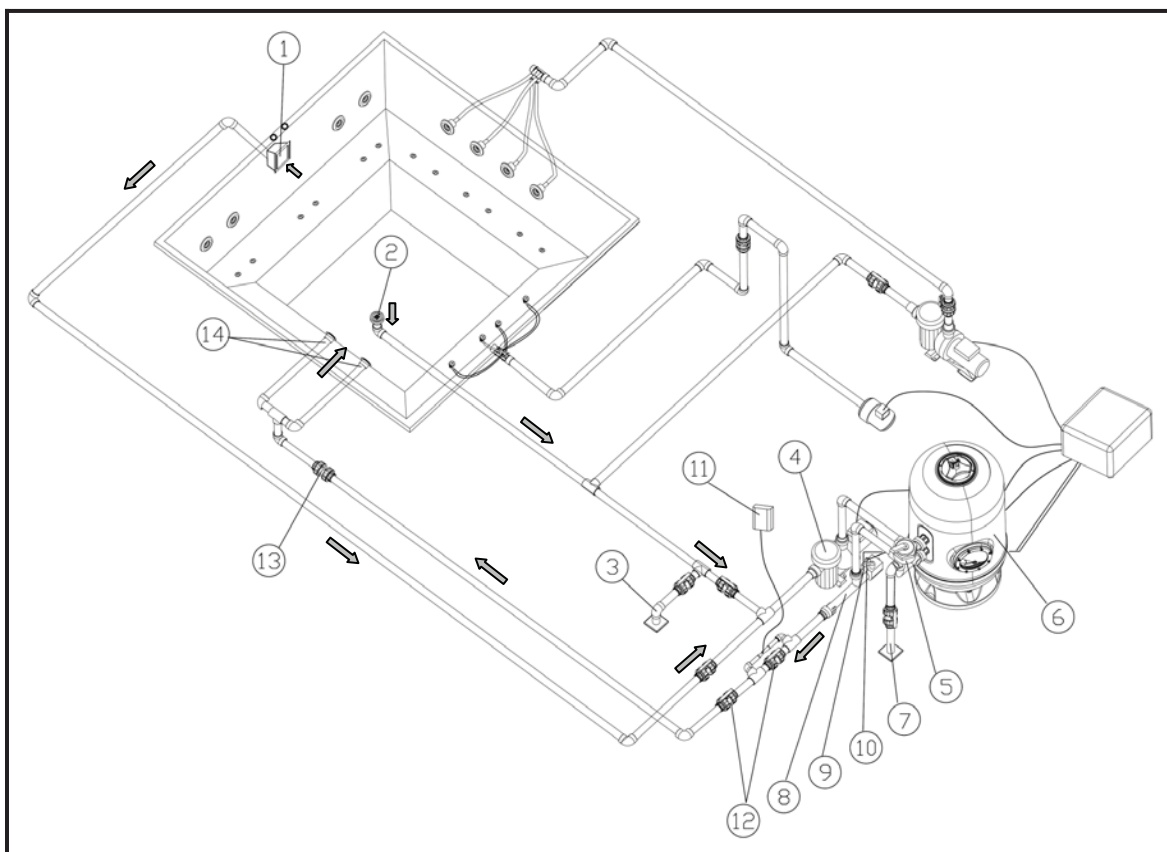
Wasserumlaufschema für einen Spa mit Skimmer
